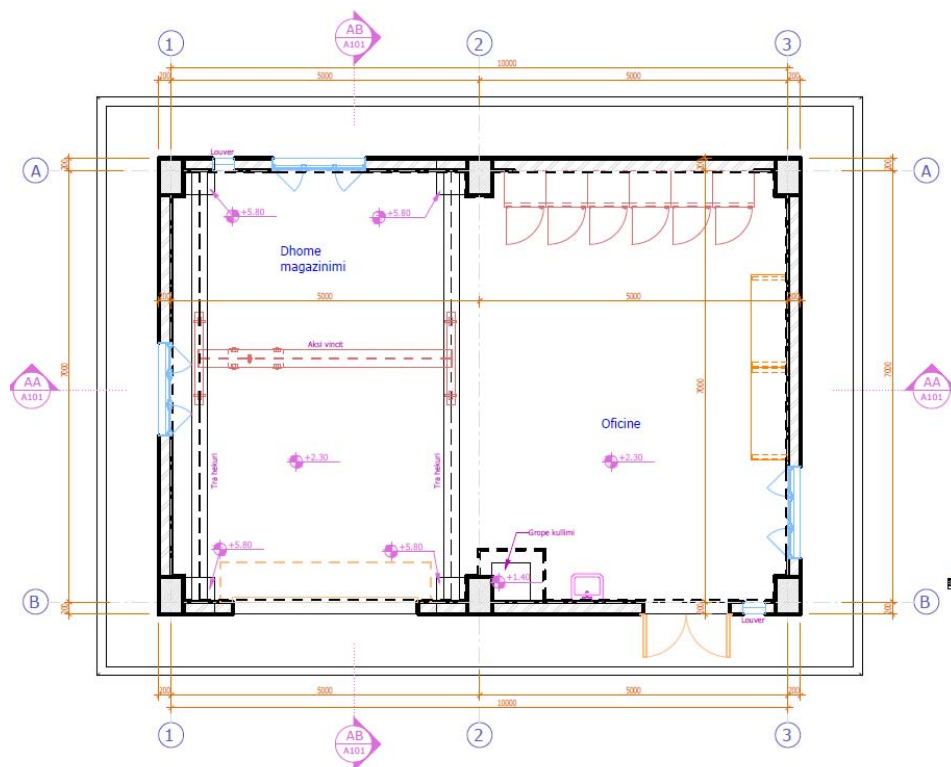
Pamje e planit të ndërtesës së magazinimit
